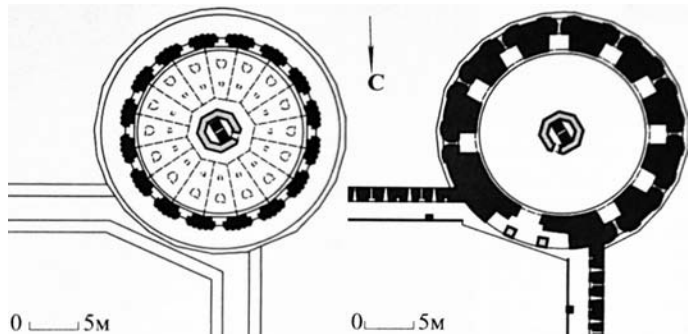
Планы башни Дуло по уровню ходовой площадки примыкающих стен и по уровню верхней ходовой площадки самой башни [12, с. 141]
